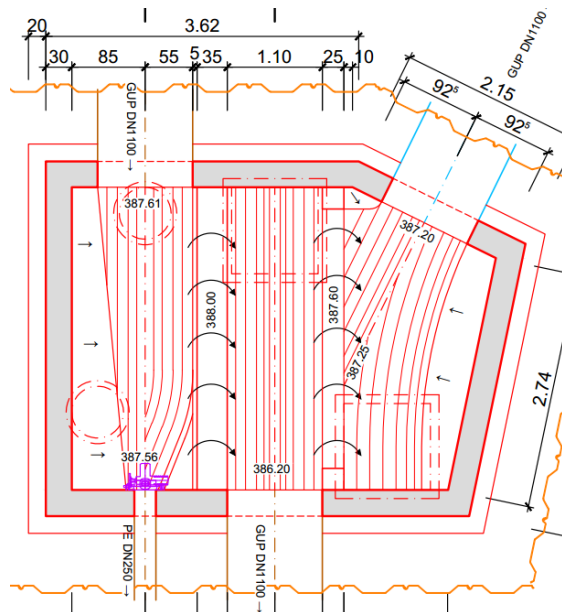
Grundriss Trennbauwerk Nord
